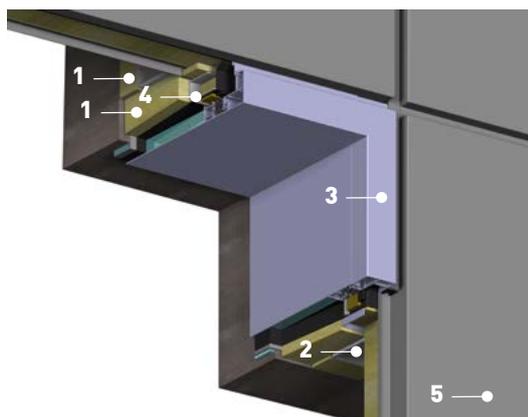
Оконное обрамление, выровненное во шве с фасадным элементом Qbiss One B – УГЛУБЛЕННЫЙ ВАРИАНТ
